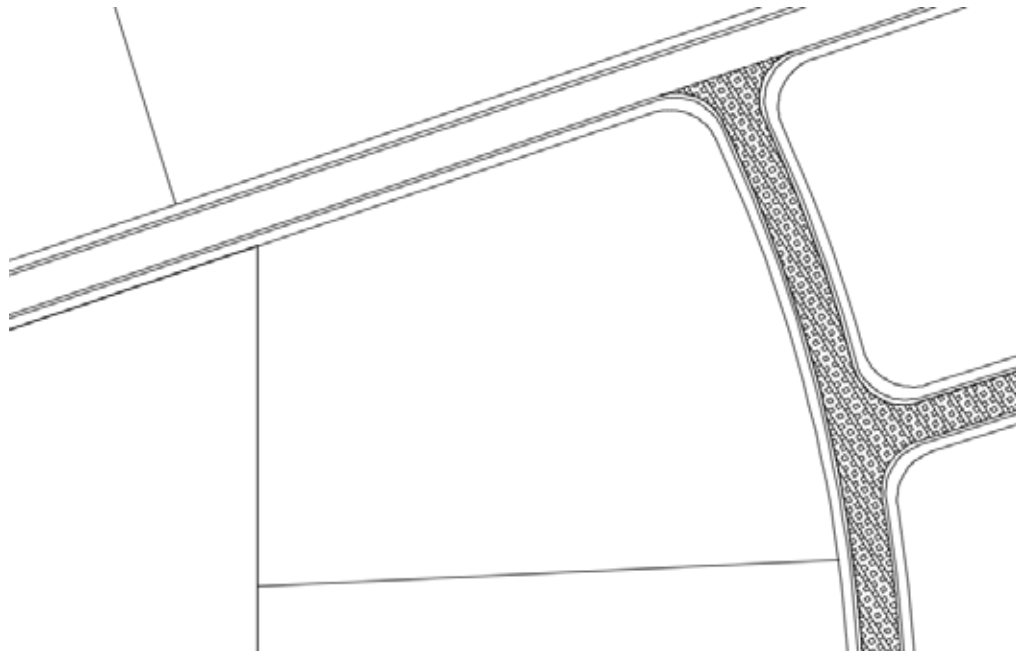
Terreno seleccionado del proyecto arquitectónico. (2018)
